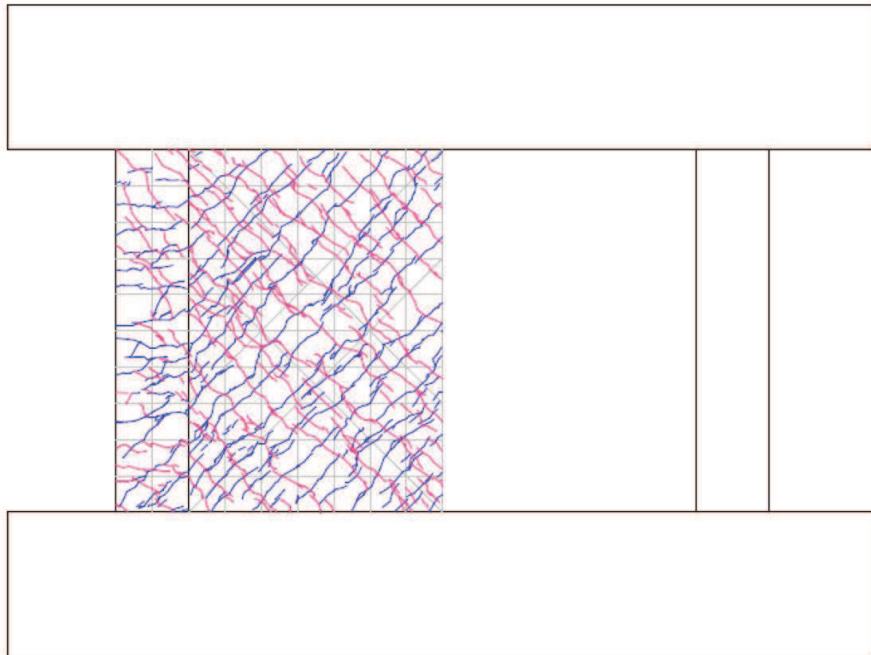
試験体 S-13-DII 6/1000rad. ひび割れ図
